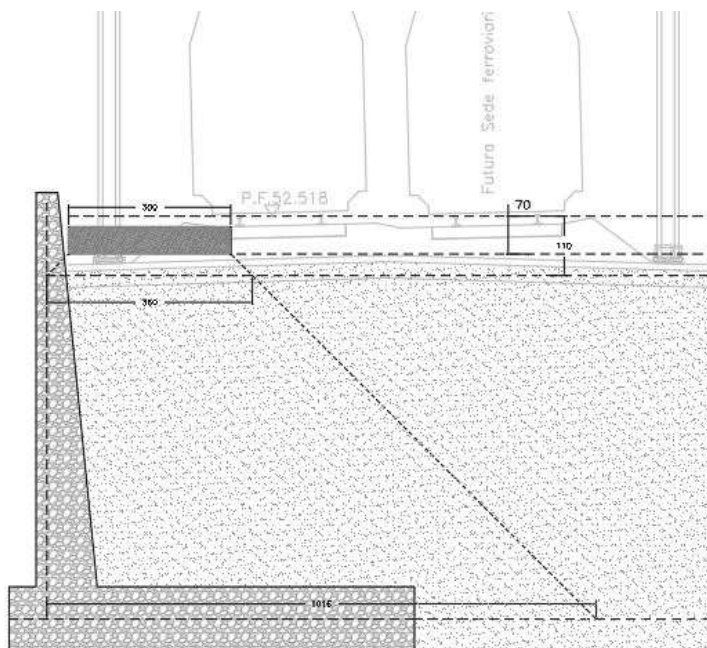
Distribuzione del carico ferroviario su sezione trasversale
